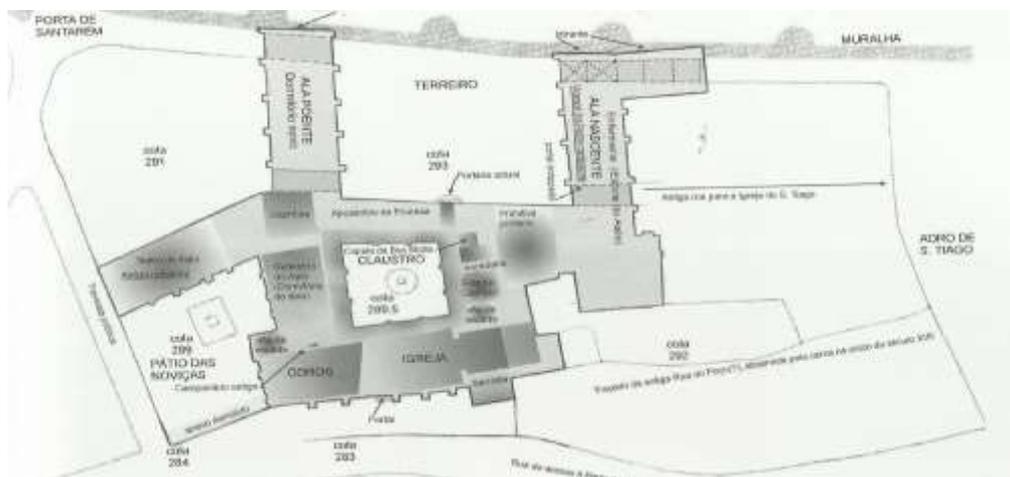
Planta do Convento da Saudação<sup>173</sup>
